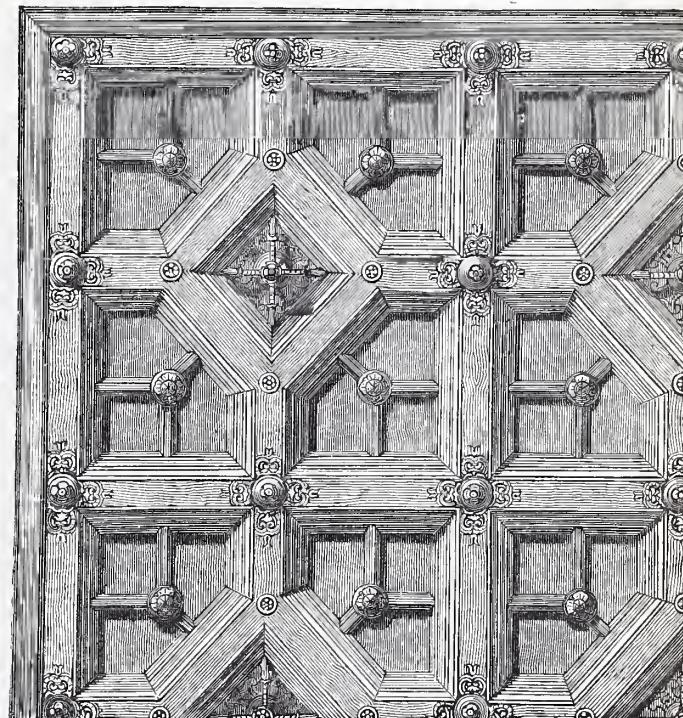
Plafond. Zu Art. Holzdekoration.
